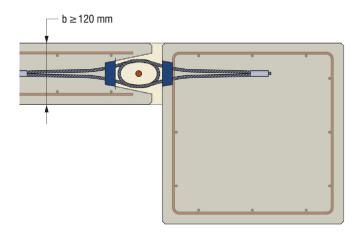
Stütze – Wandverbindung (planer Einbau)
